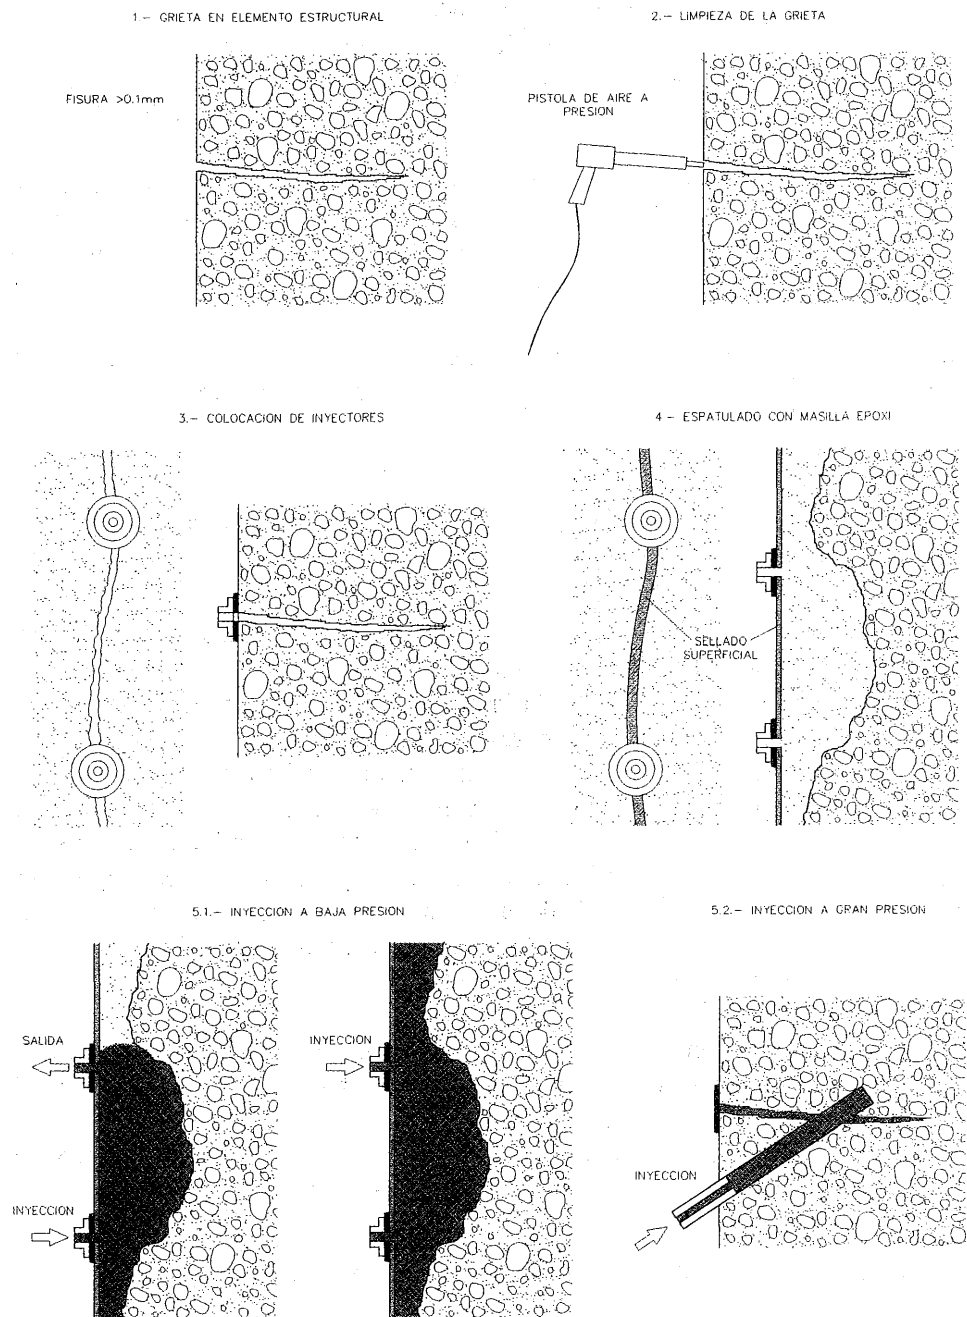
11. Reparación de fisuras por inyección de resinas a baja y alta presión.
